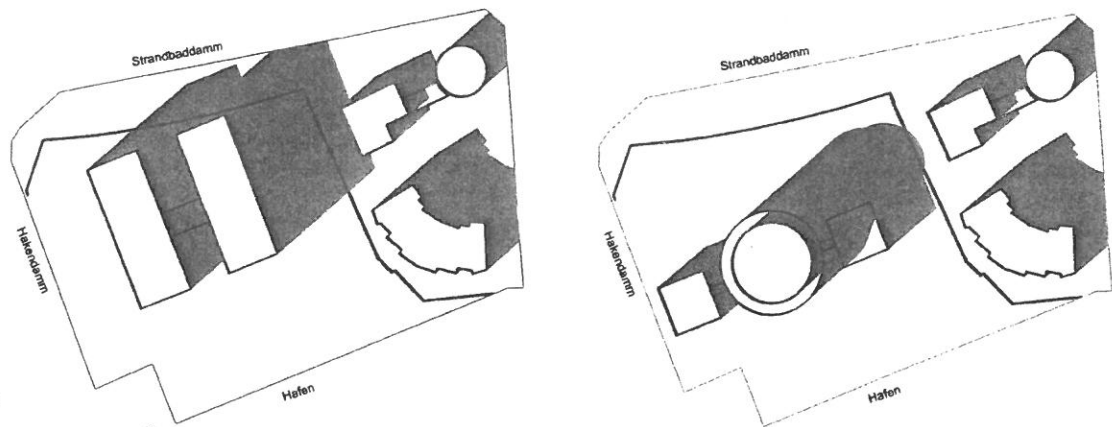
Entwurf gem. Rahmenplan 2008 (links) und Vorhabenplanung 2017 (rechts);
